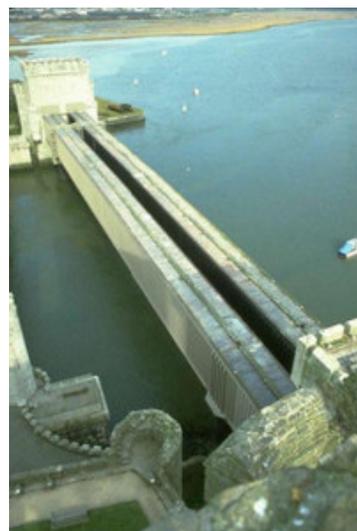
Ponte Conway, Inglaterra. Vista aérea. Fonte: GERKEN, 2003.
